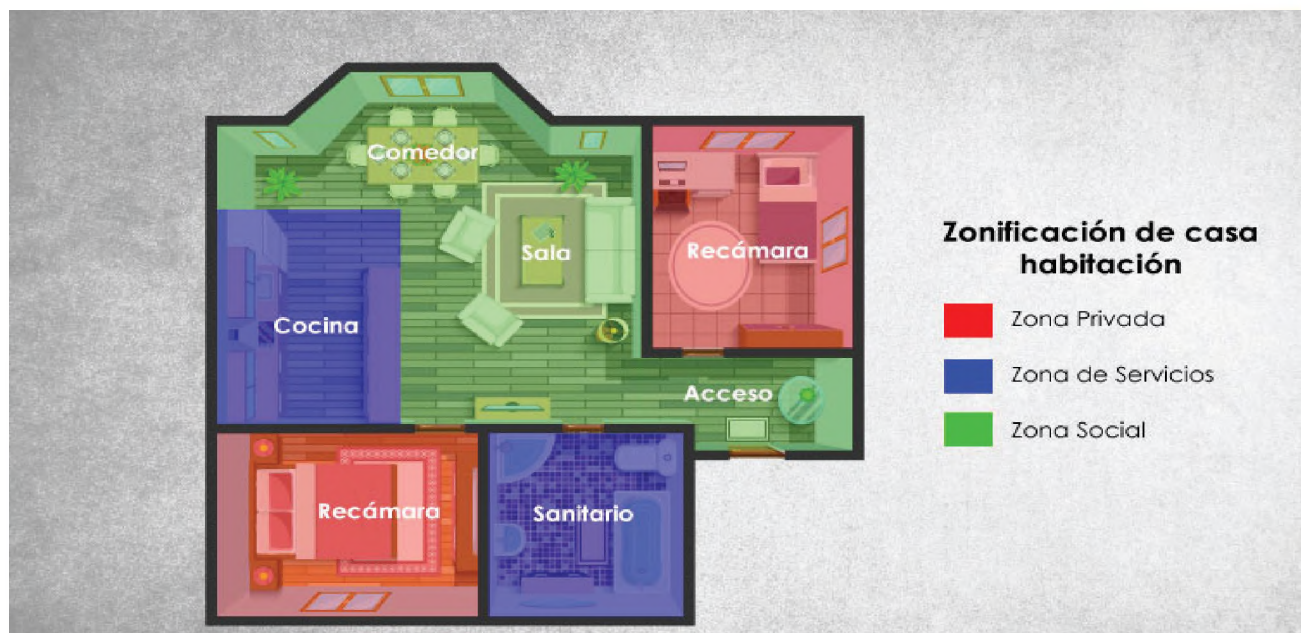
ZONIFICACIÓN EN VIVIENDA (www.soyarquitectura.mx)
